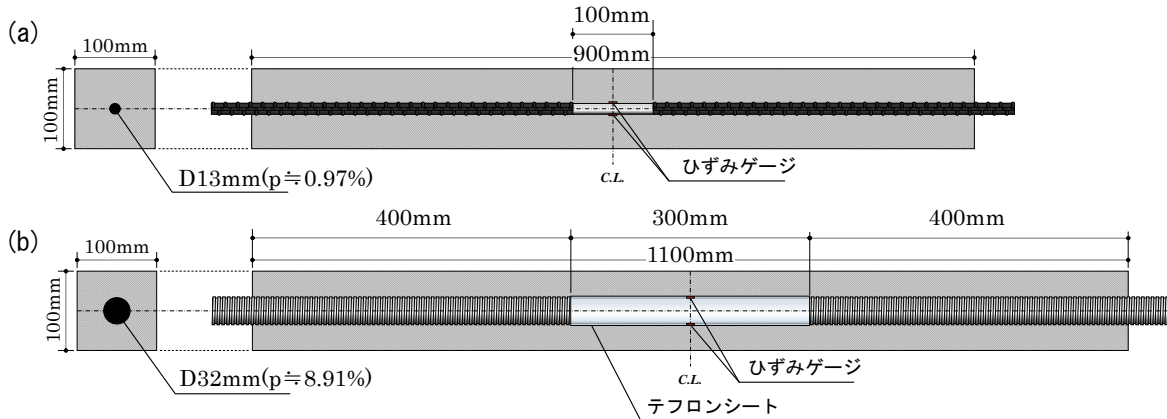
拘束試験体 (a)一軸拘束, (b)拘束ひび割れ
